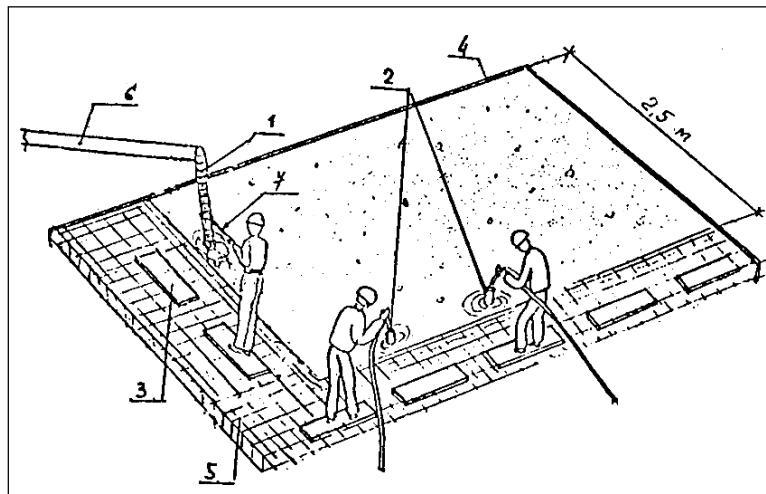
Схема организации рабочего места при бетонировании монолитной плиты
